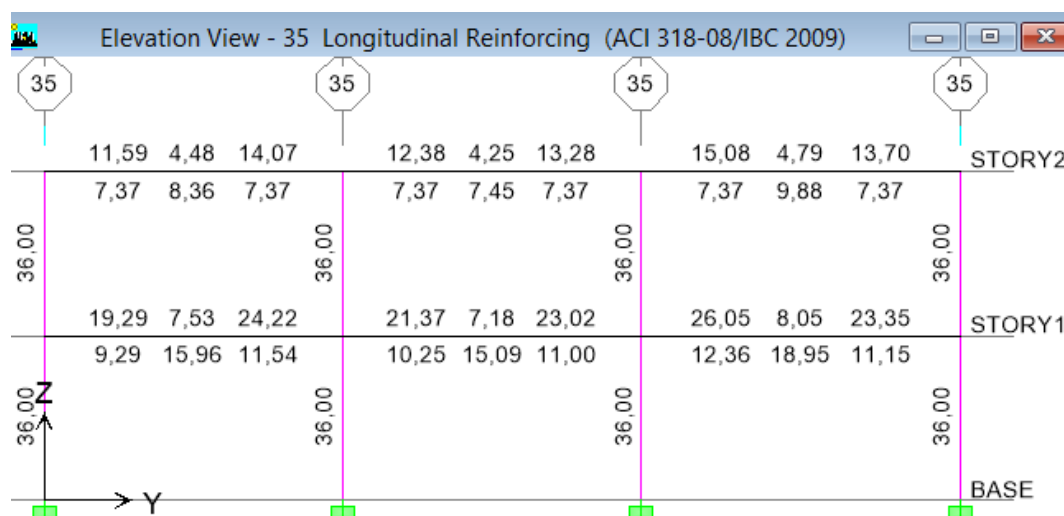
Acero en Vigas y Columnas en el Pórtico 35 – C. Quirúrgico- (CEC2002)
